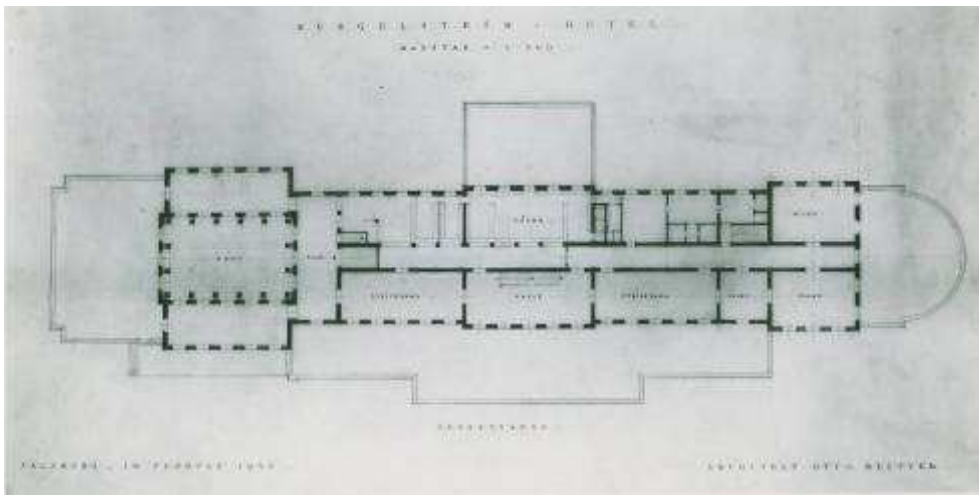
Otto Reitter, Grundriss, Erdgeschoss, *Bürgelstein-Hotel*, Salzburg, Februar 1943 (Sammlung Ostheim).
